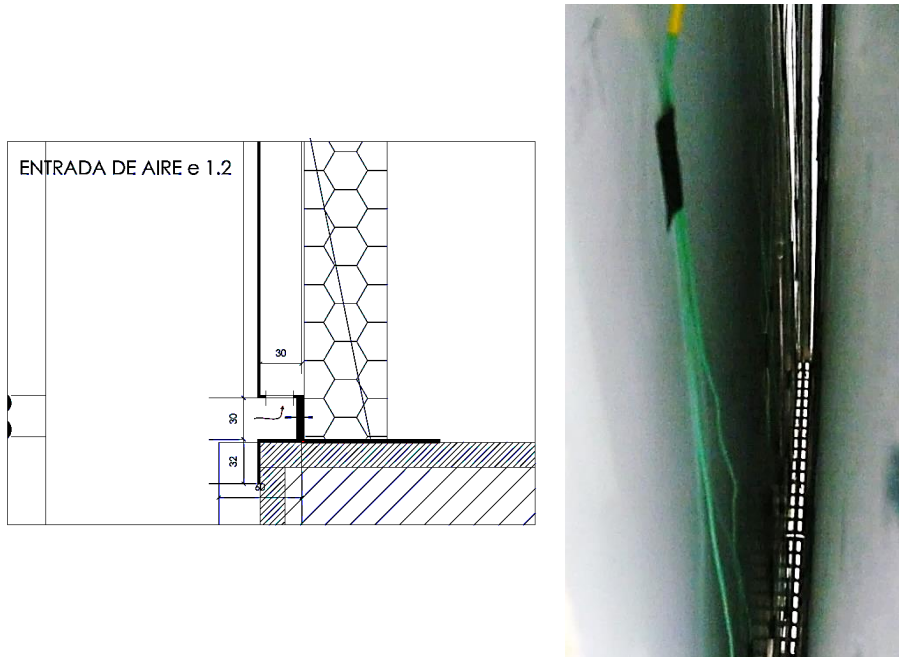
Zona de entrada de la cámara ventilada en la fachada forzada
